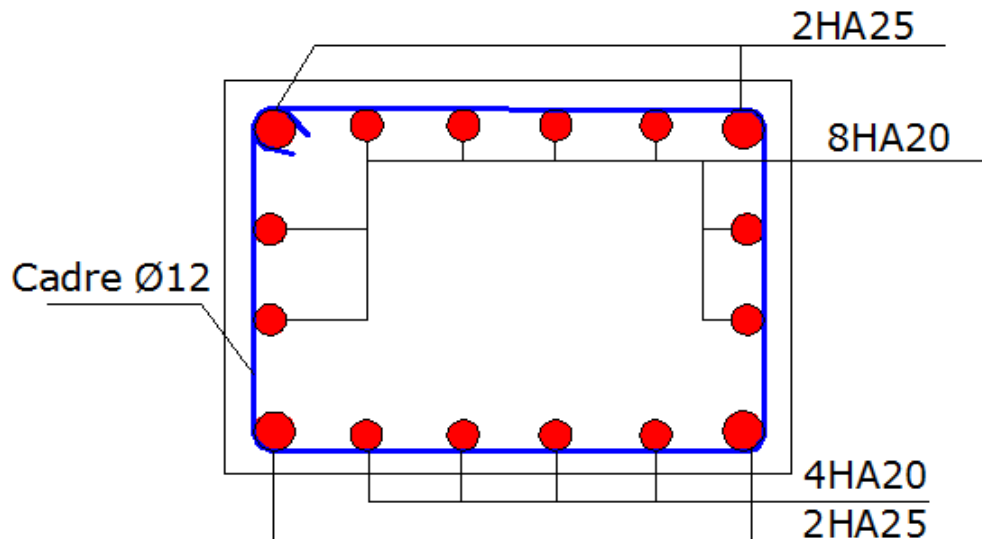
Schéma de ferrailage du fût de la semelle type (III)
